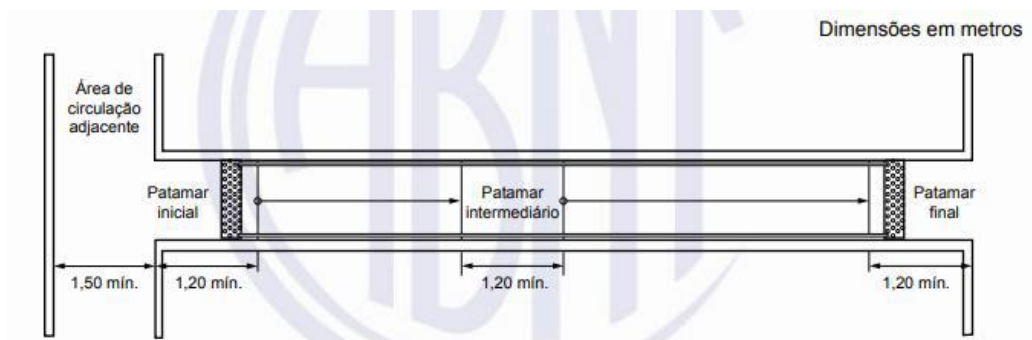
Patamares das rampas (Fonte: NBR 9050)
